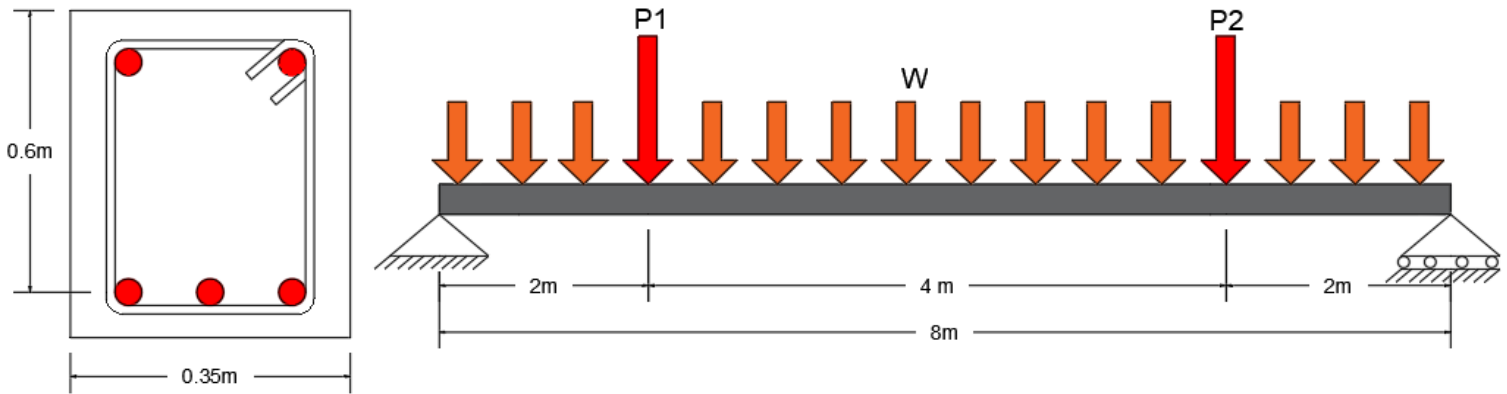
Detalles de viga - sección transversal y longitudinal.
